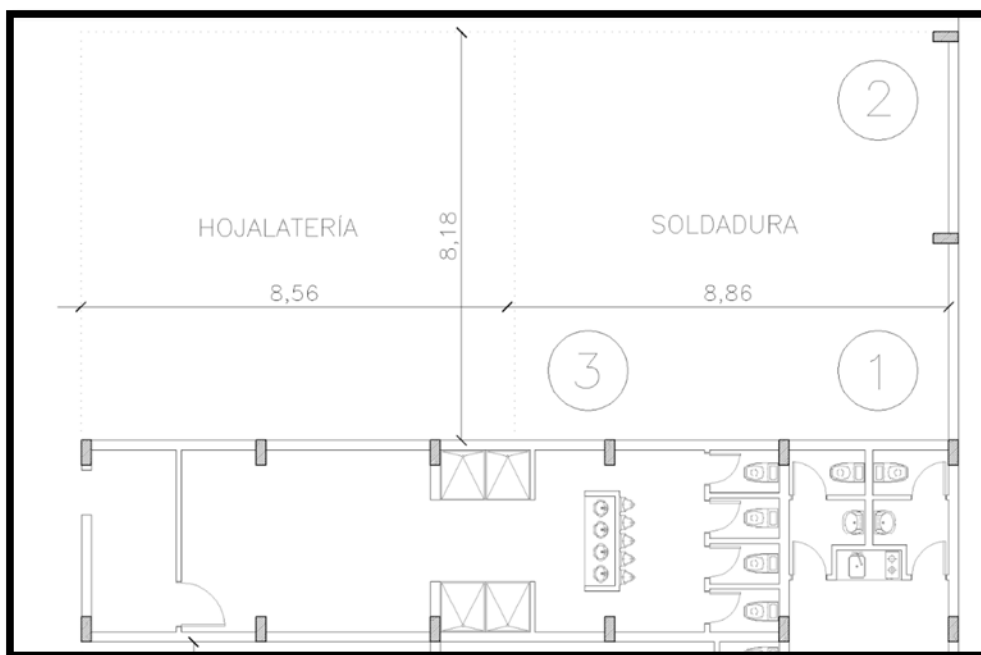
CROQUIS SECCIONES SOLDADURA- MEDICIÓN DE RUIDO - Fuente: Propia
